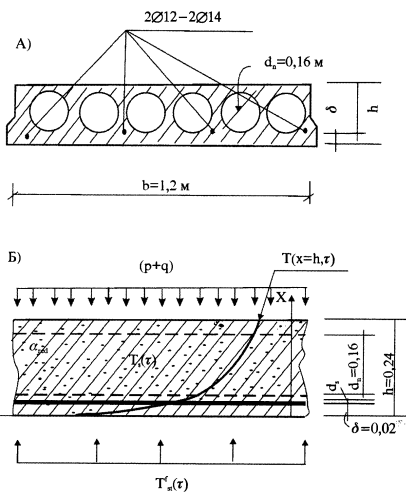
К расчету предела огнестойкости железобетонной, многопустотной плиты перекрытия
